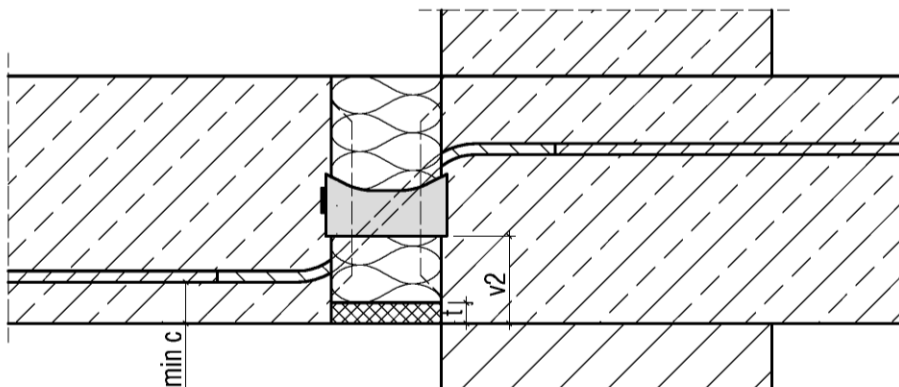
Schöck Isokorb® Typ Q (Ausführungsvariante B) gem. Abschnitt 3.1.2
